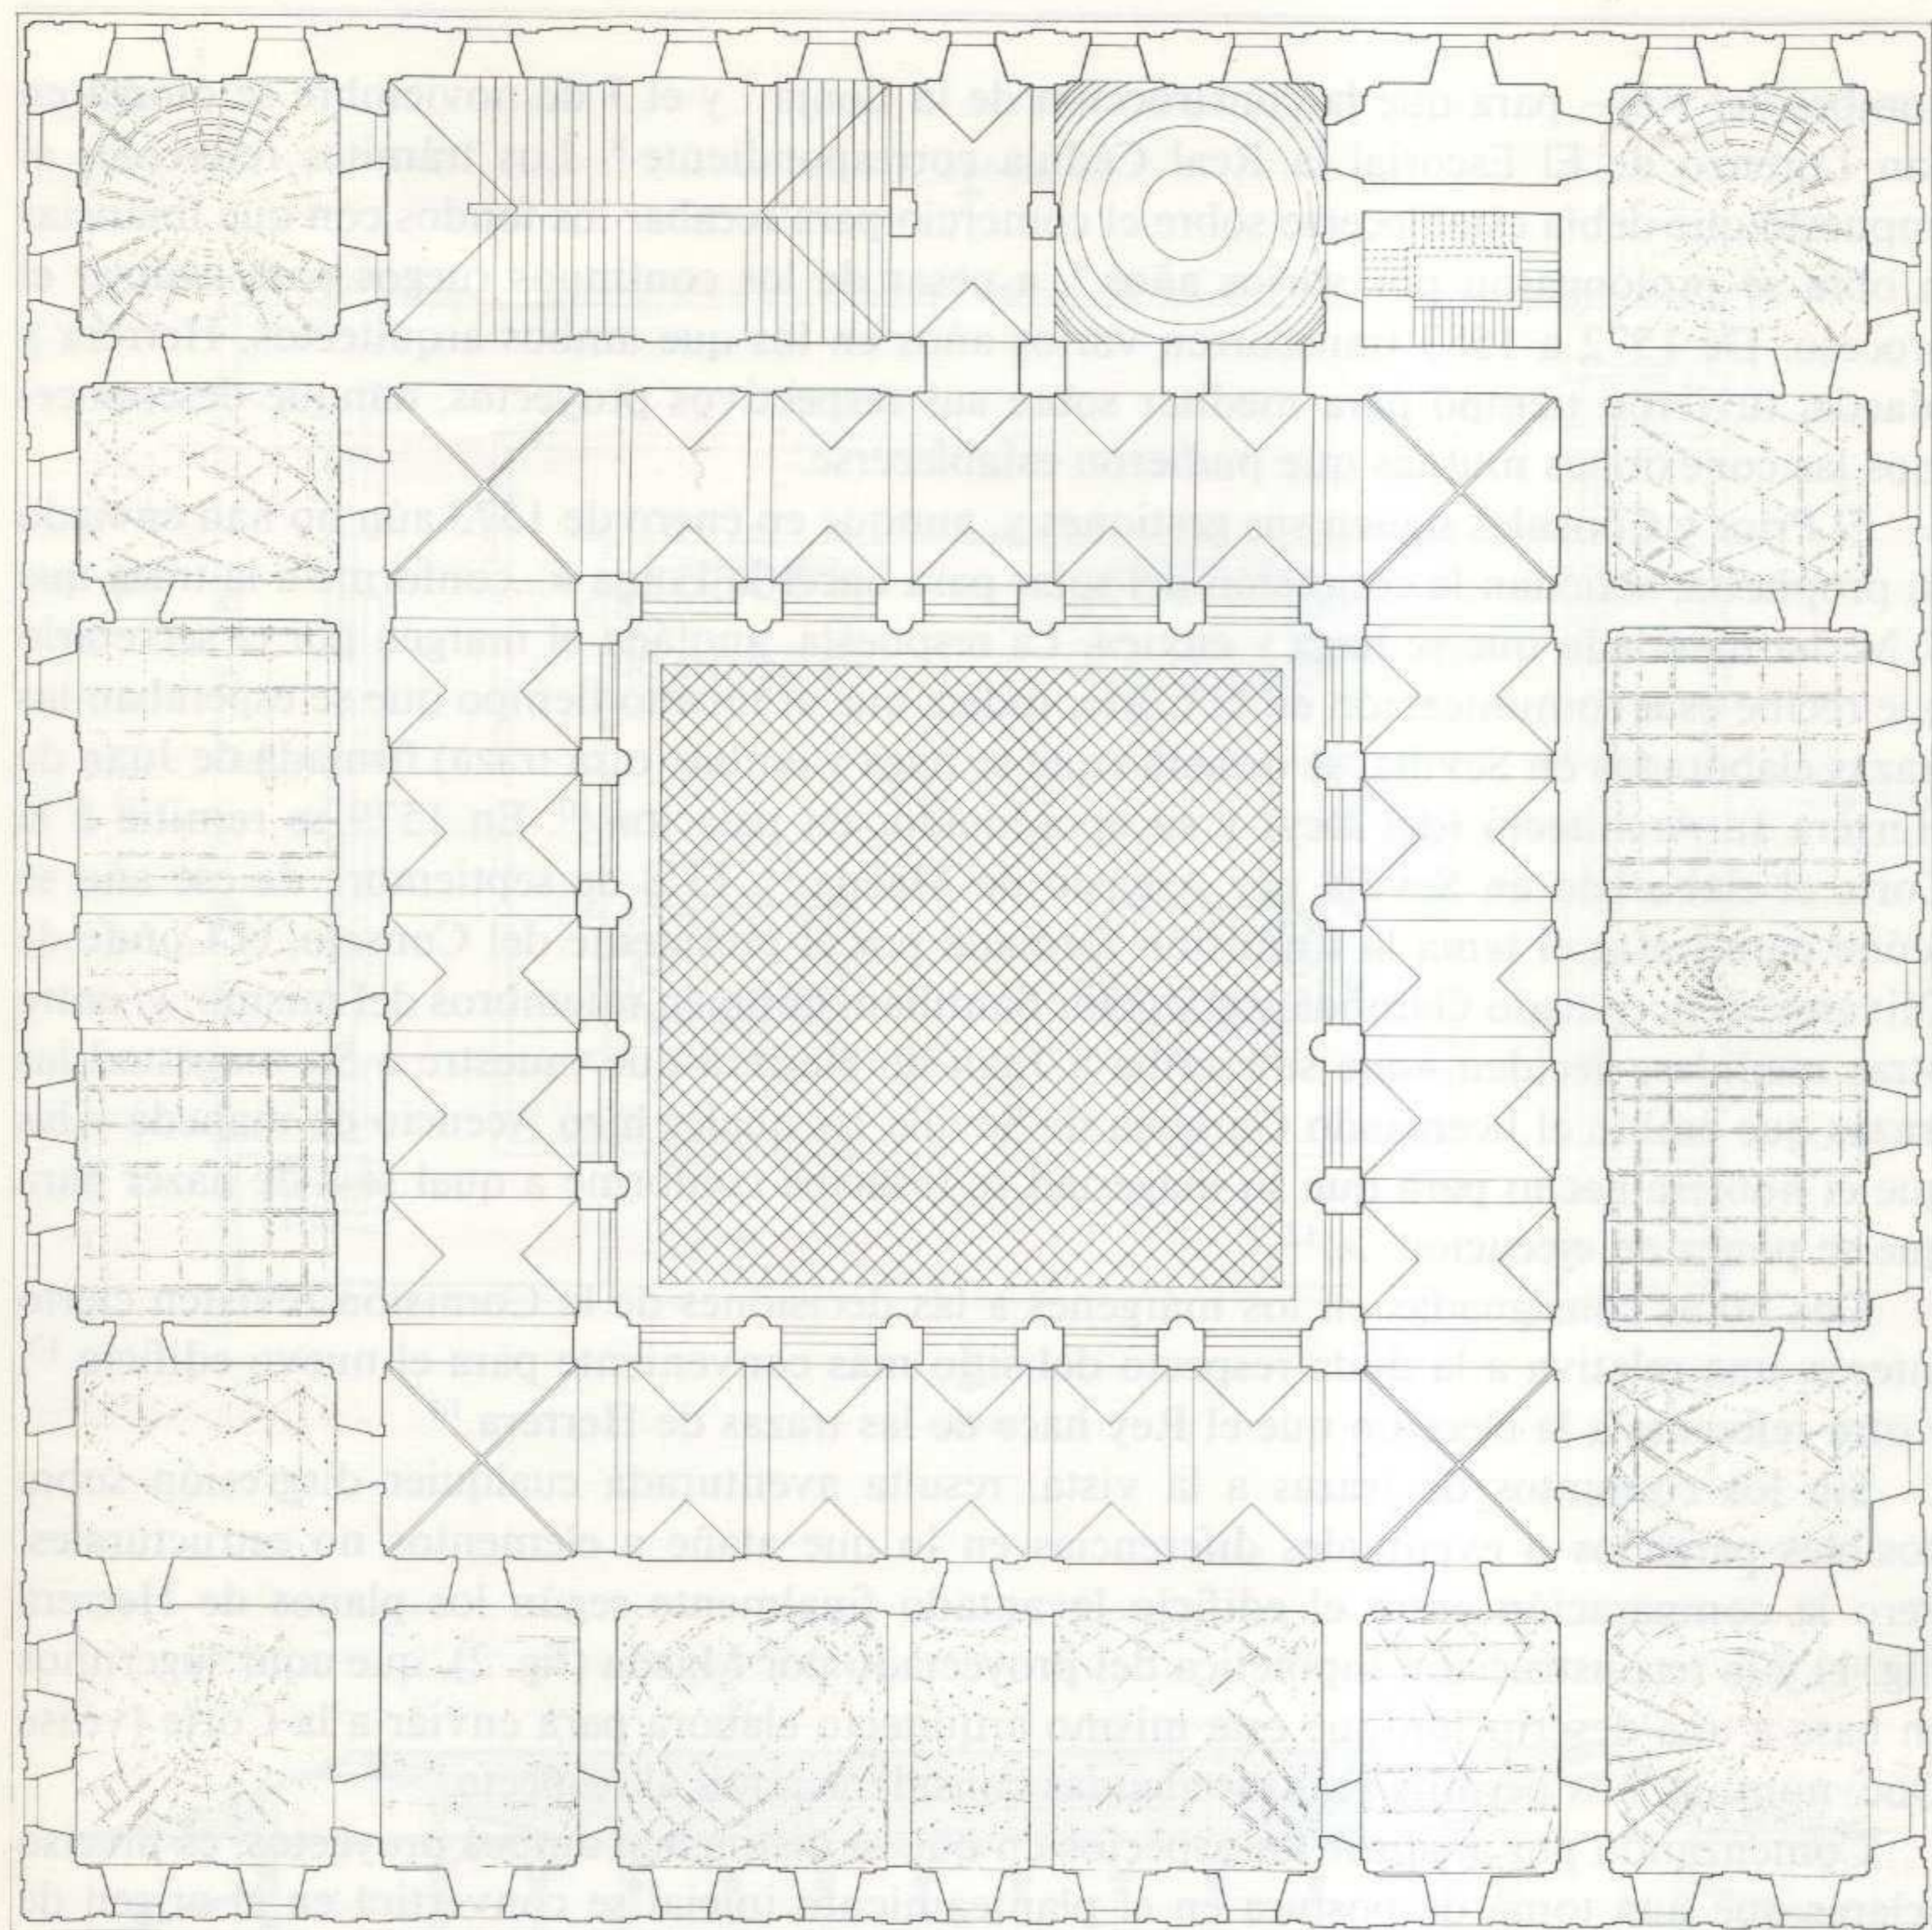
Herrera. Planta y alzado para la *Lonja de mercaderes de Sevilla
